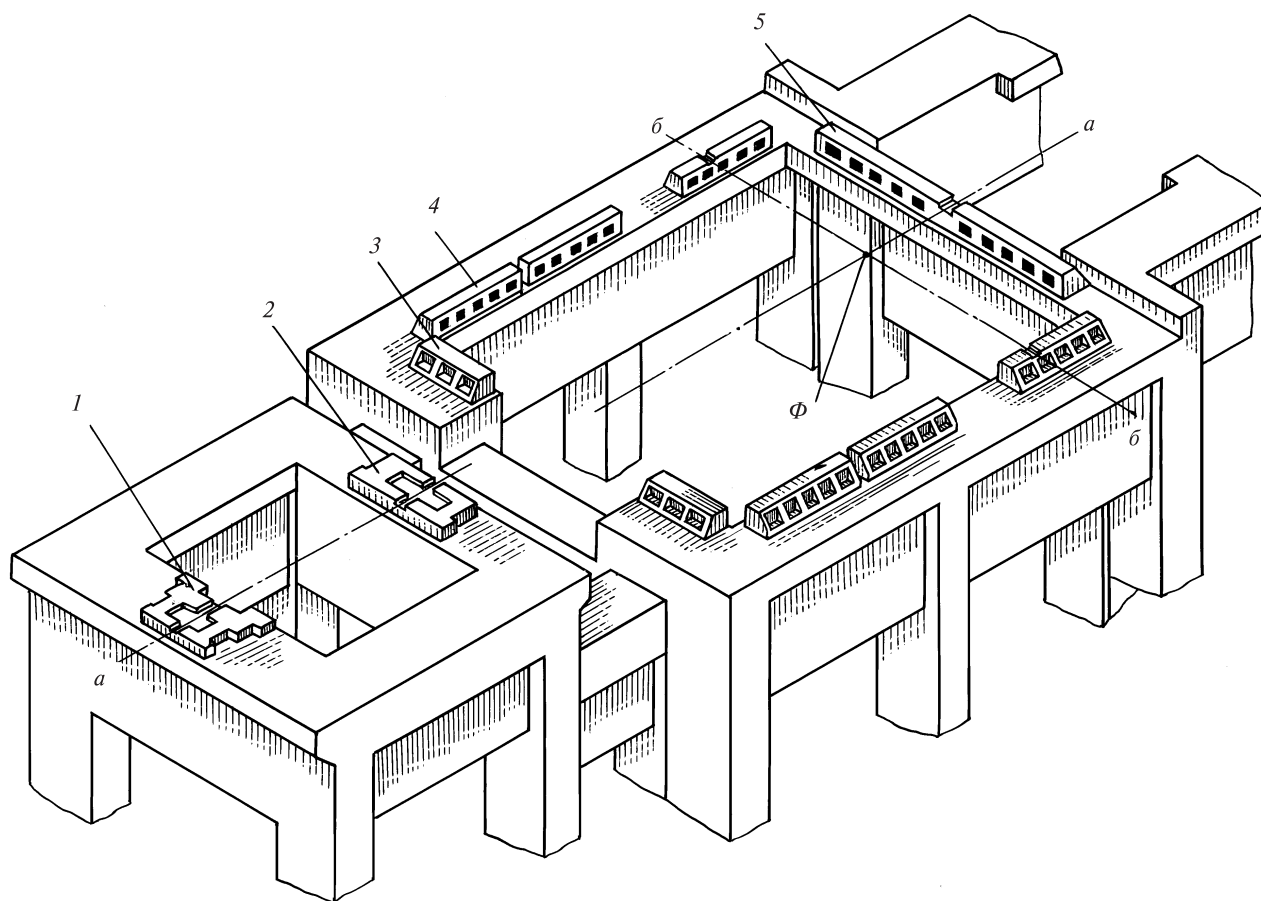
Установка фундаментных рам под турбину на верхней фундаментной плите
